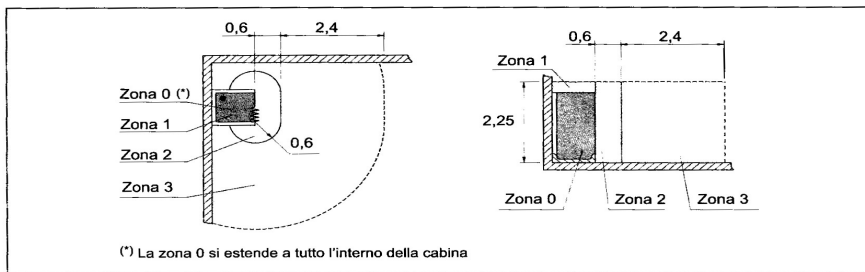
Individuazione delle zone nei locali con docce prefabbricate (quote in metri). La zona 0 si estende a tutto l'interno della cabina.
